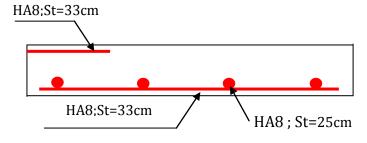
Vue en coupe du ferraillage de la dalle des balcons
